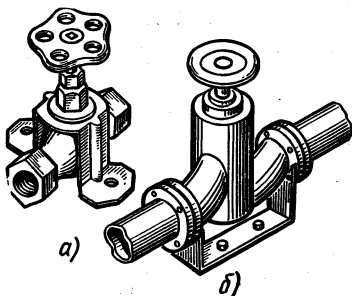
Крепление резьбовой (а) и фланцевой (б) арматуры на пластмассовых трубопроводах
